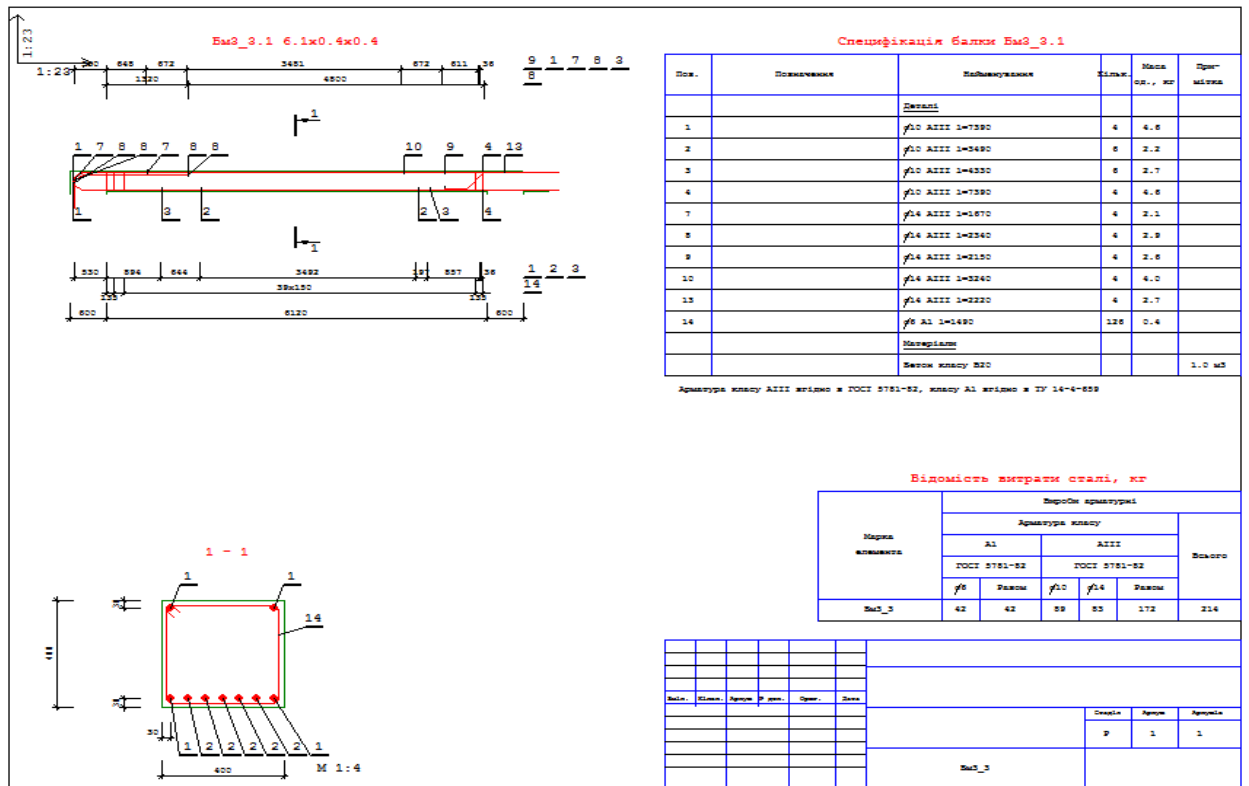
Варіант будинку з балочно - плитним перекриттям. Балка Б3-3. Креслення робочого проекту
